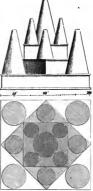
Restaurirter Grundriss und Aufriss des Porsenagrabes.
